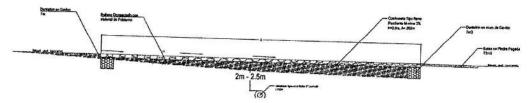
Corte de como quedarán las tuberías profundizadas bajo una colchoneta Tipo Reno en Piedra y Muros Gaviones en los Taludes.
